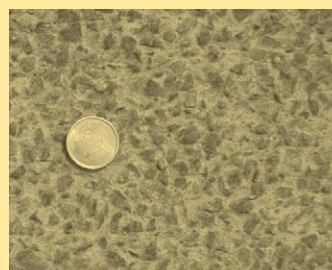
Betondecke mit fehlerhafter Waschbetonstruktur
